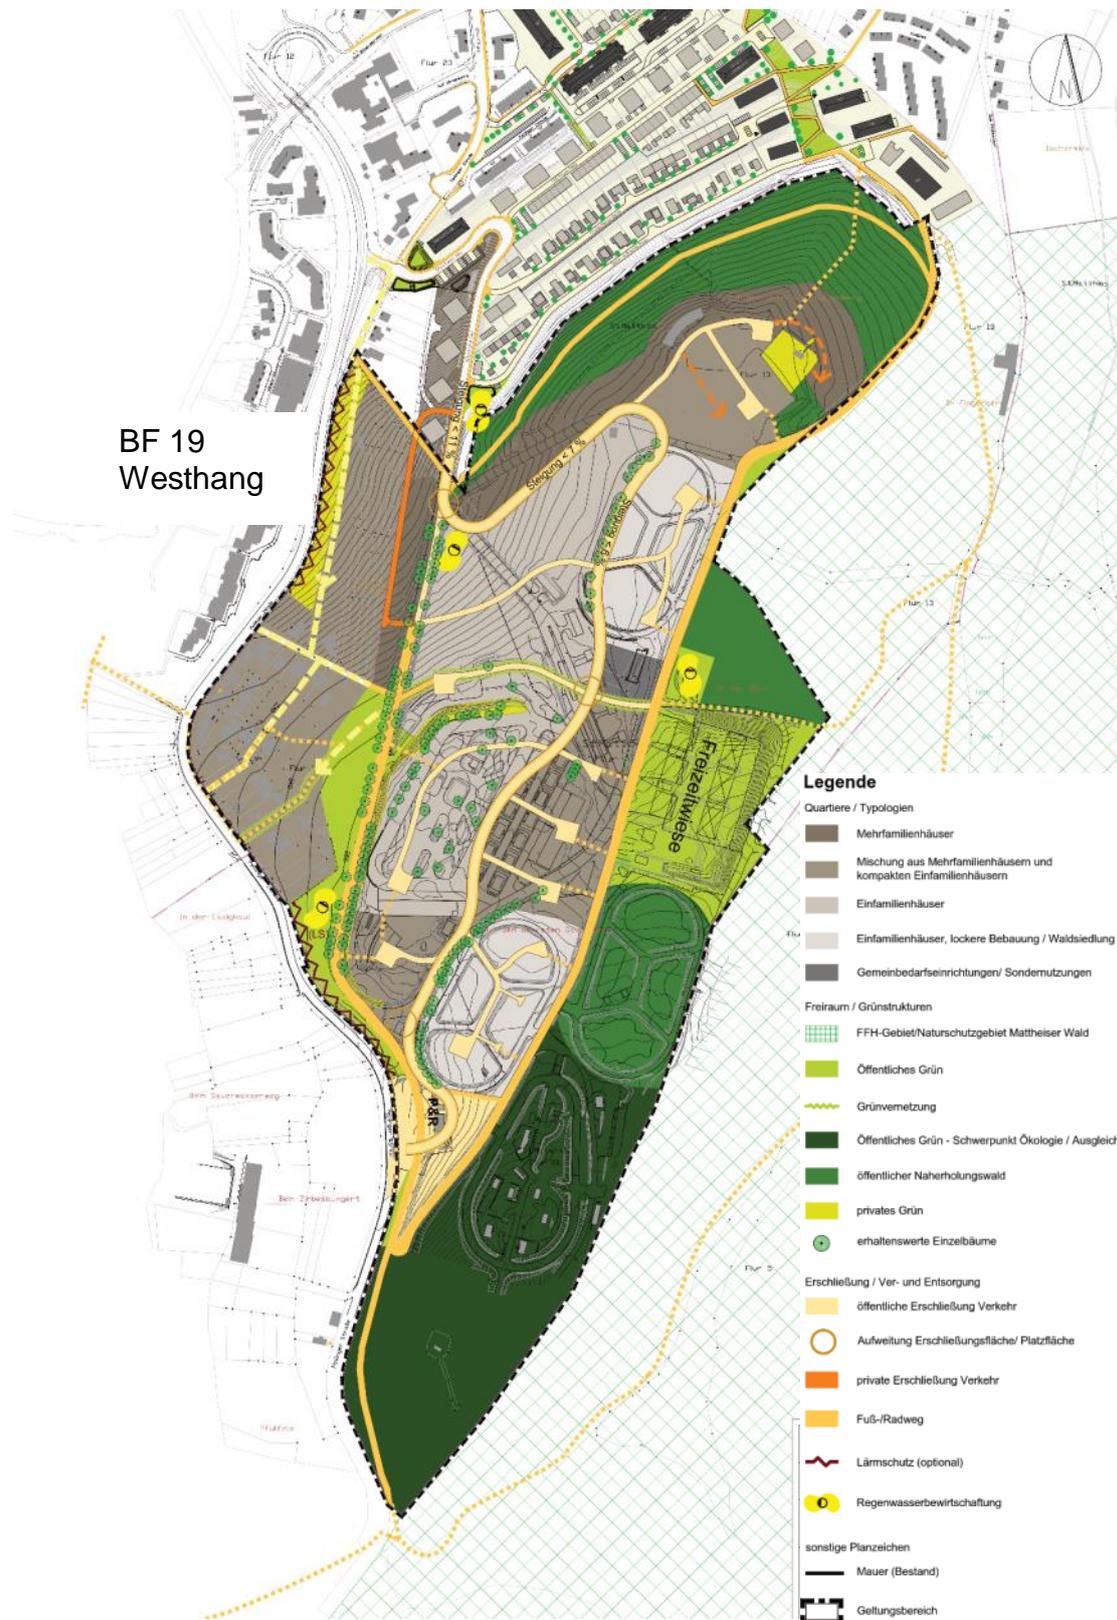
Städtebaulicher Quartiersrahmenplan „Ehemaliges französisches Übungsgelände – Castelnau II“
